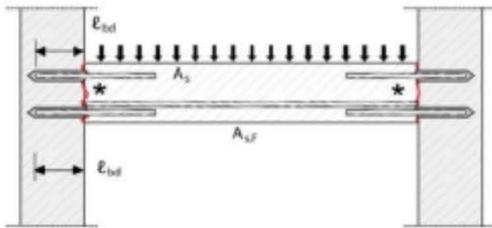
Chevauchement des joints dans les dalles et les poutres.
